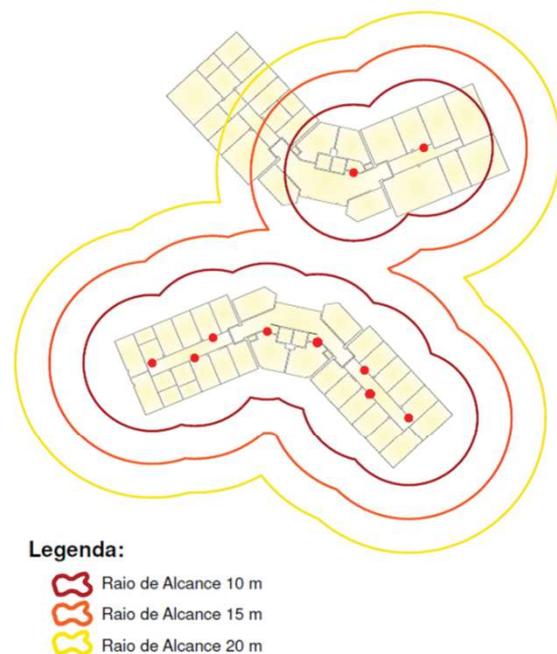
Localização e raio de alcance das unidades extintoras do Terceiro Pavimento.
